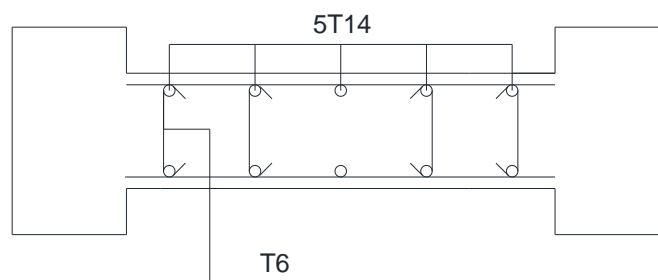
Schéma de ferrailage du voile (plan avec longues travées)
